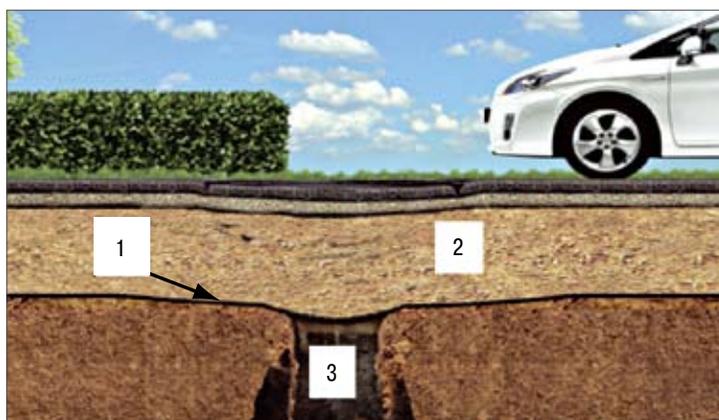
Армирование зон возможных провалов (1 – георешетка Fortrac AM; 2 – автодорожная насыпь; 3 – воронка обрушения)
